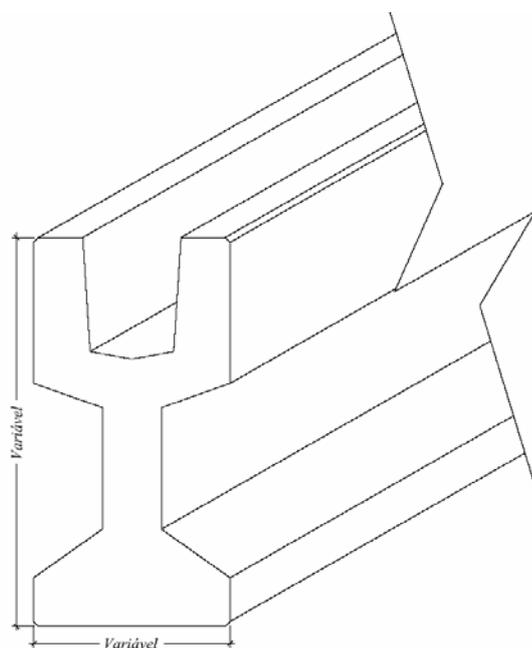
Detalhe da seção da viga calha “I”.
